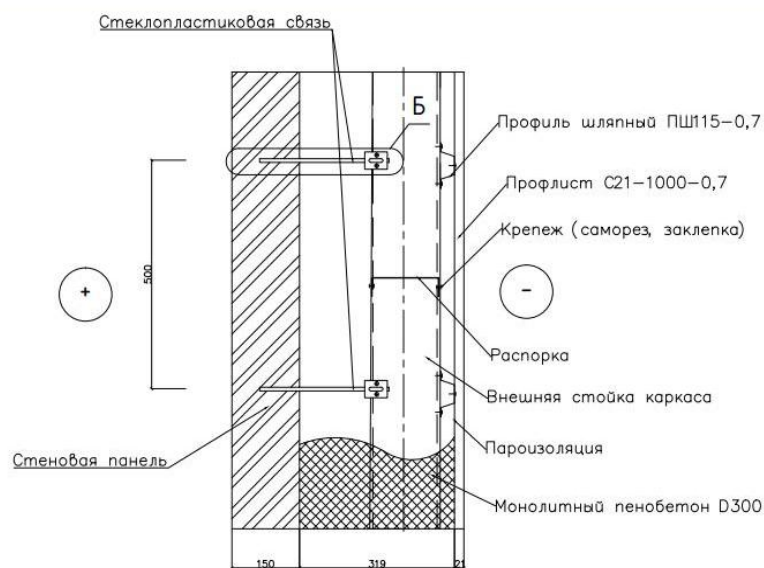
Фасадная система из пенобетона и металлического профилированного листа смонтированная на железобетонной стене
